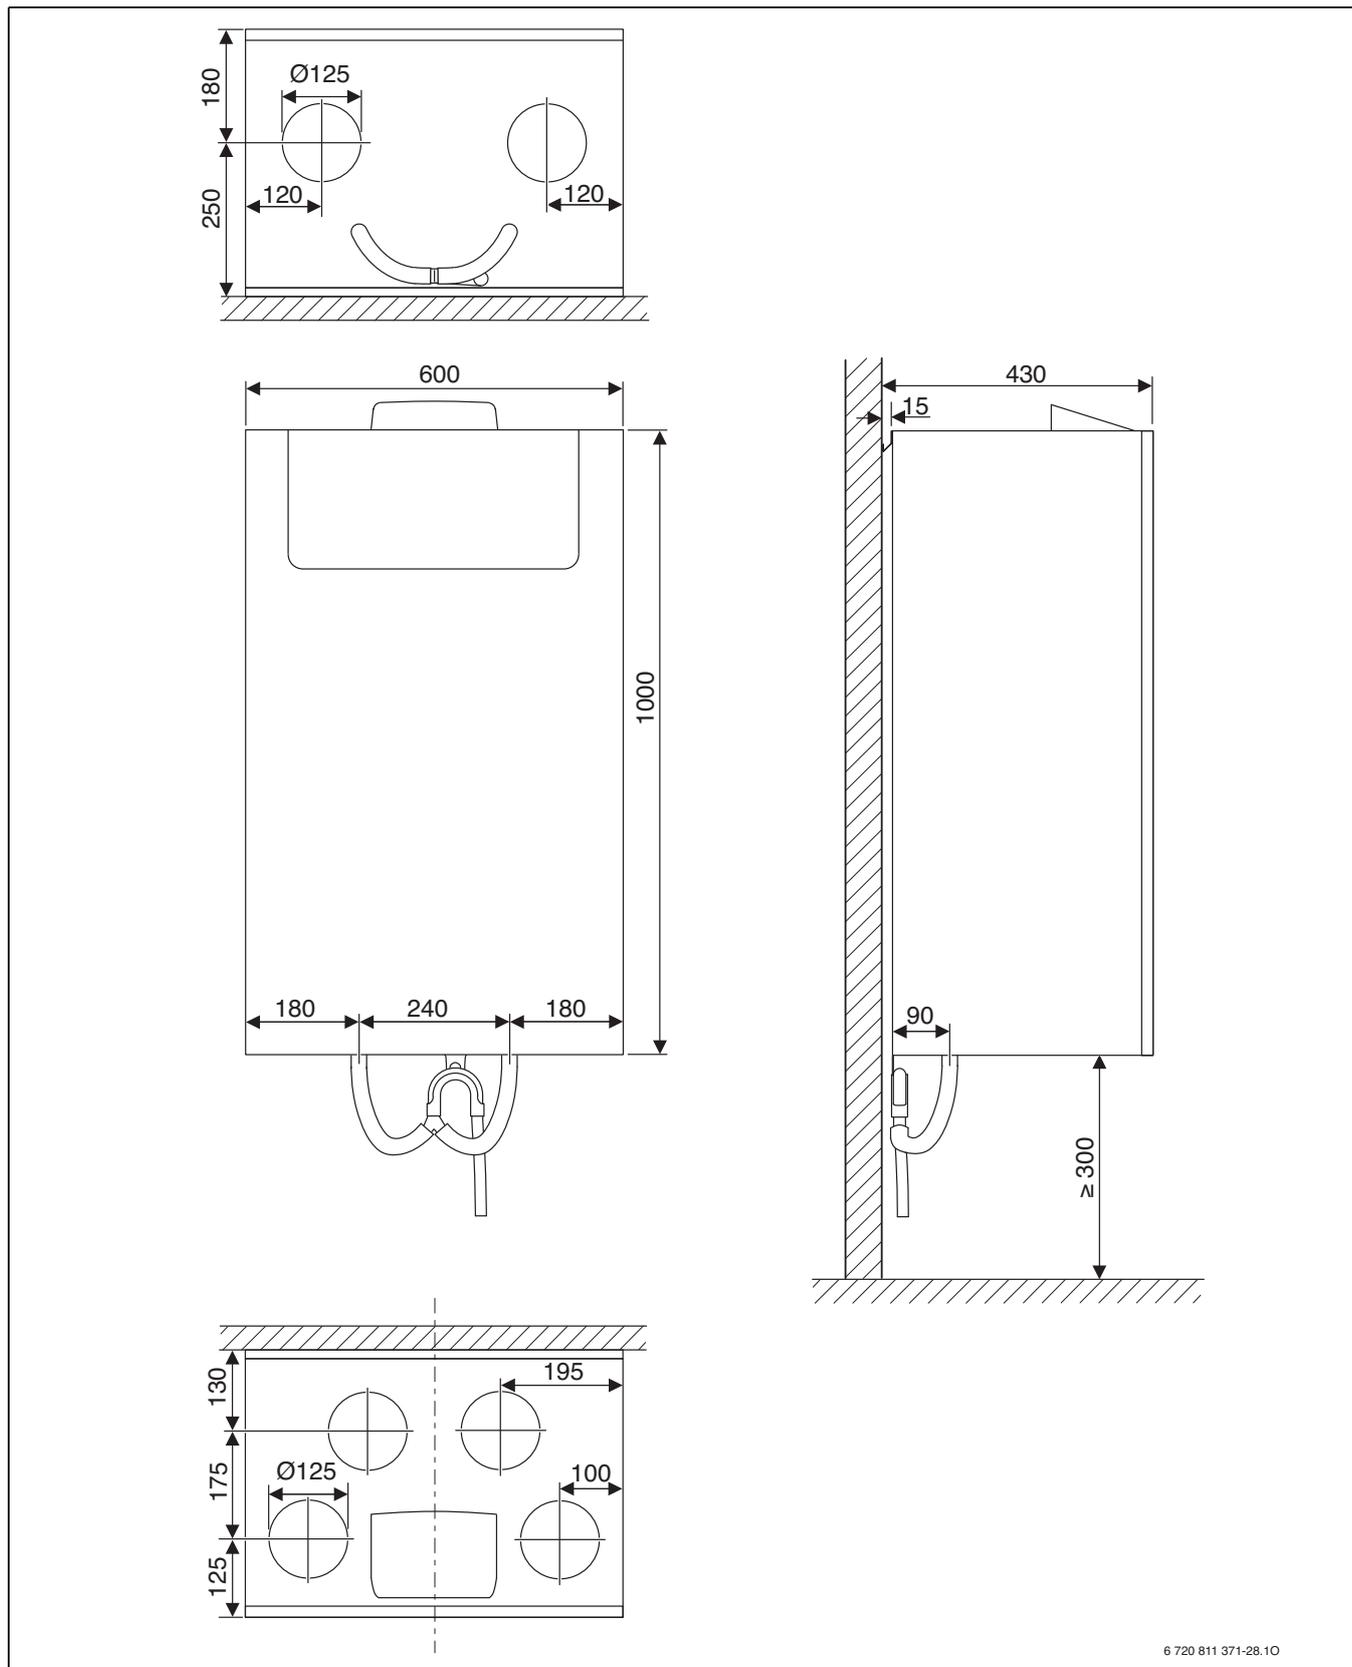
Logavent HRV2-140 (dimensioni in mm)
